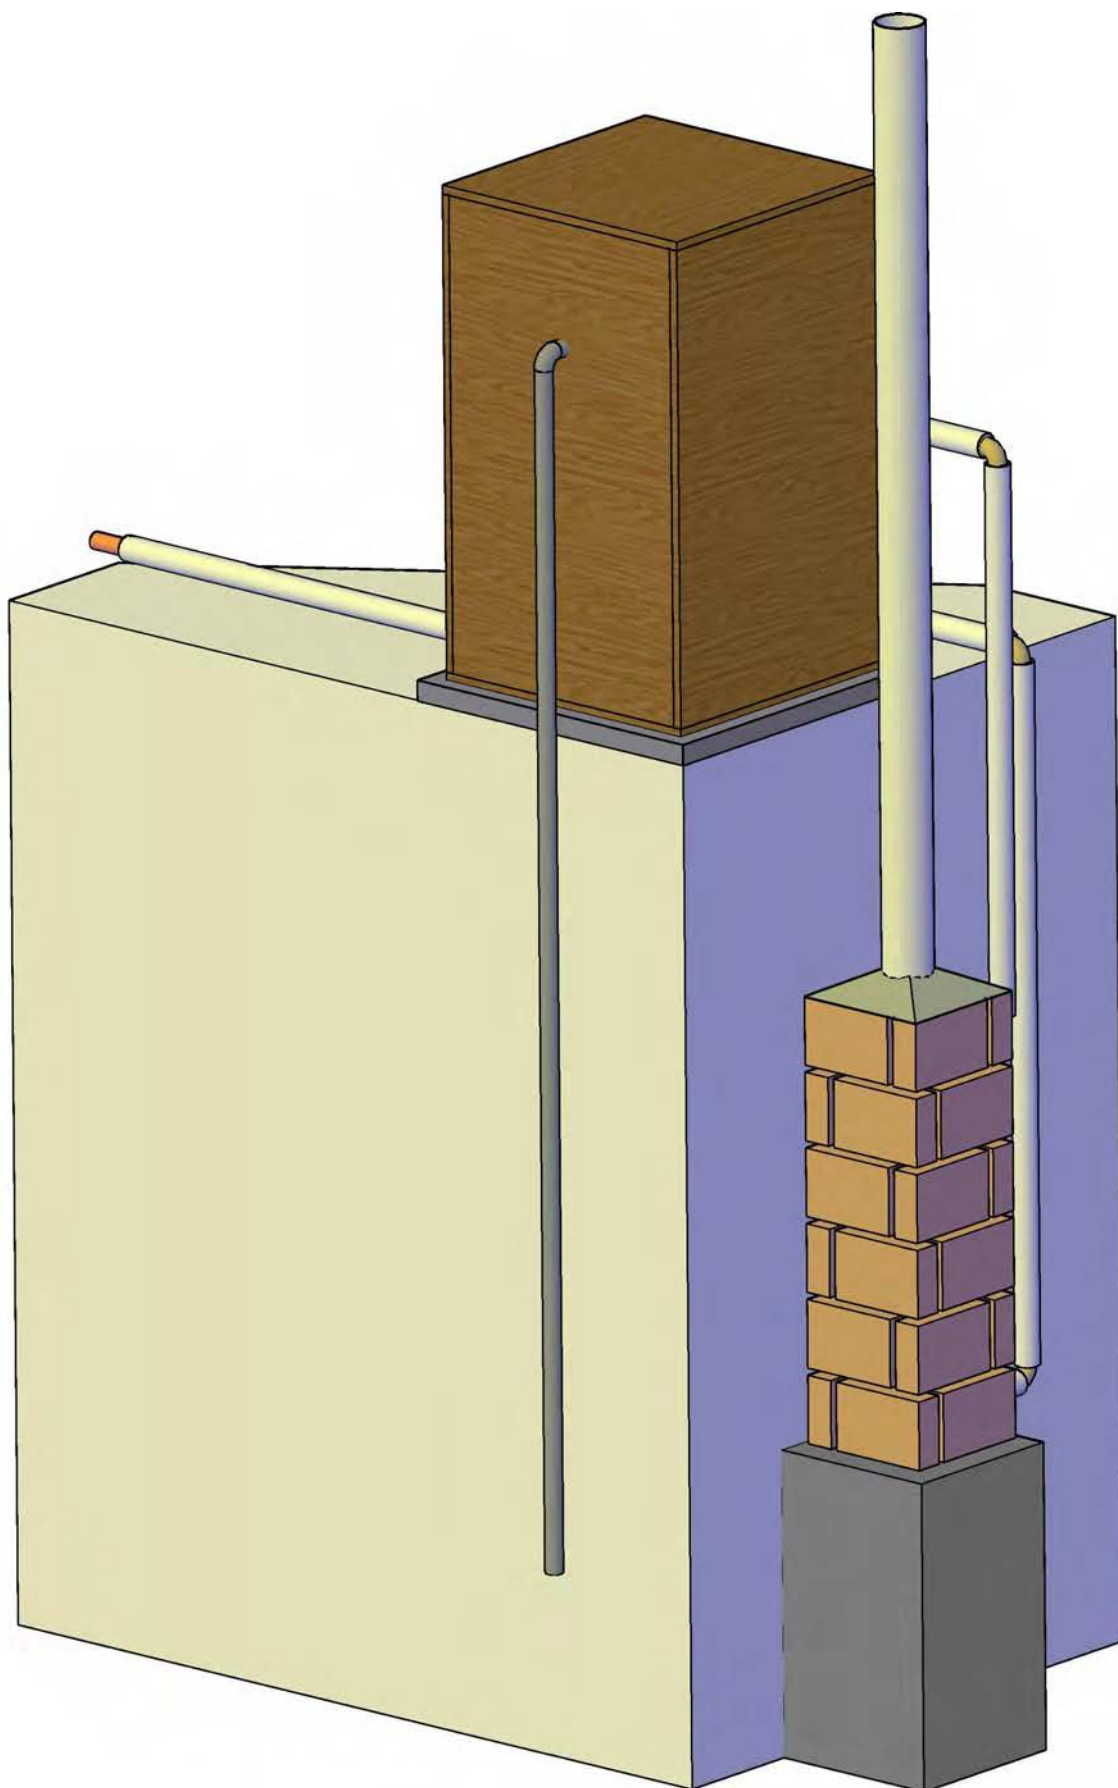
Vista de los componentes del sistema instalados en el exterior de la vivienda
